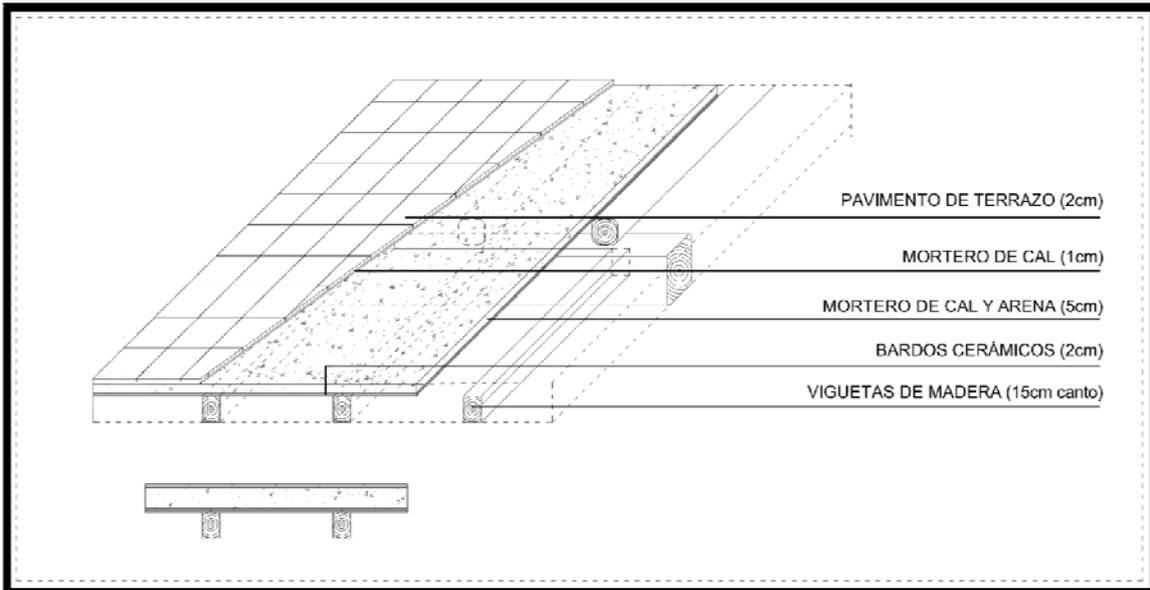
Detalle del encuentro del forjado original y del forjado de construido en la reforma
